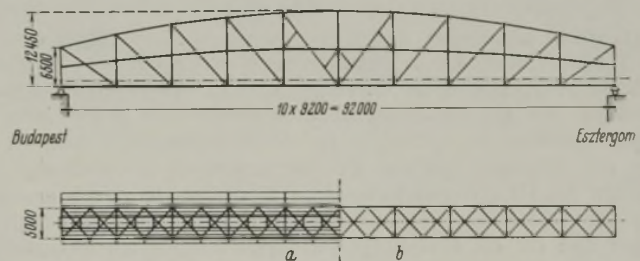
Überbau einer Öffnung vor der Verstärkung.
